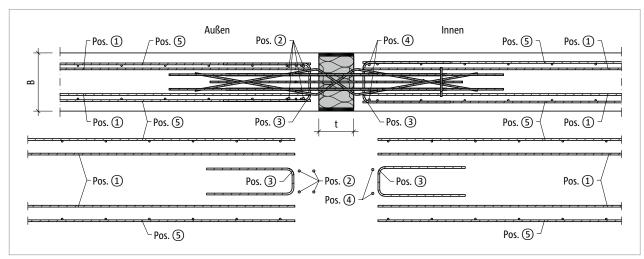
Schöck Isokorb® XT Typ W: Bauseitige Bewehrung; Grundriss
